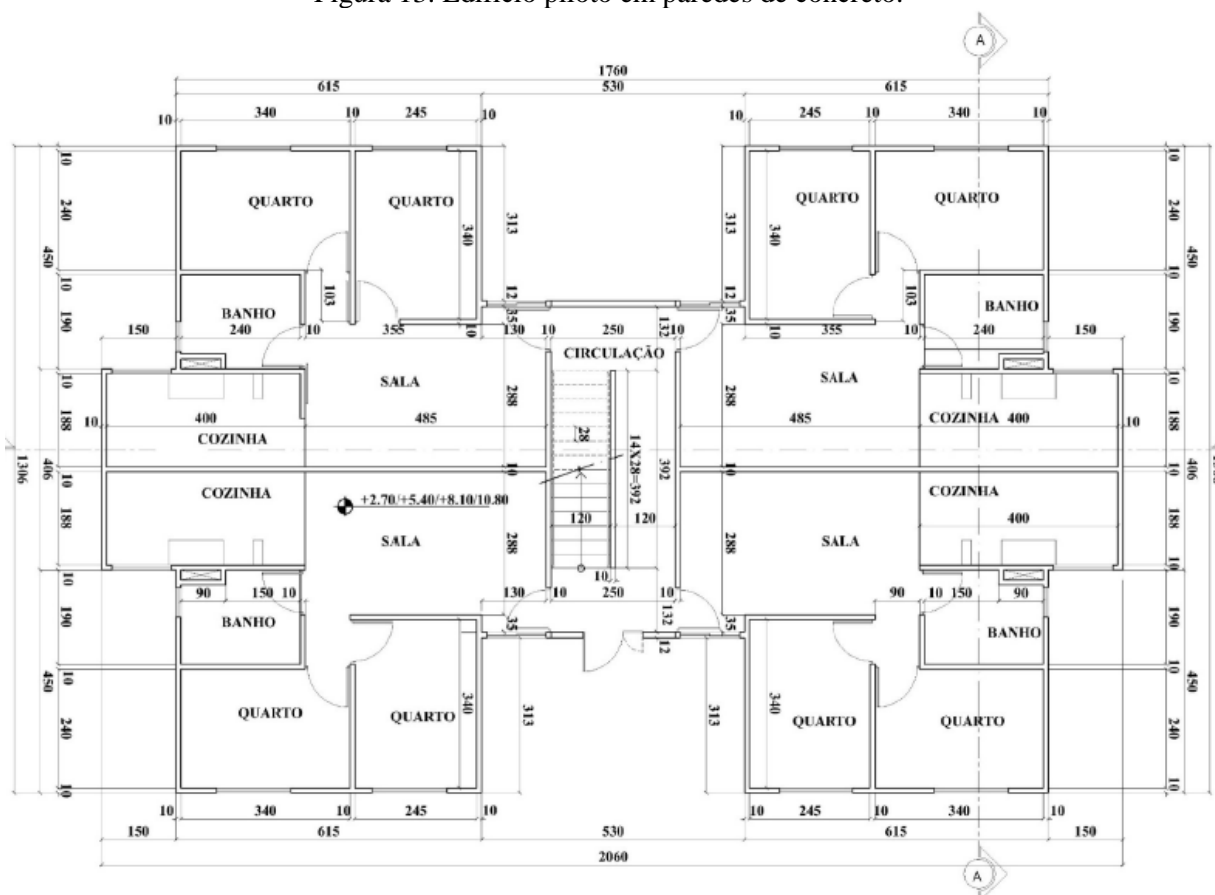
Planta baixa do edifício piloto (pavimento tipo).
